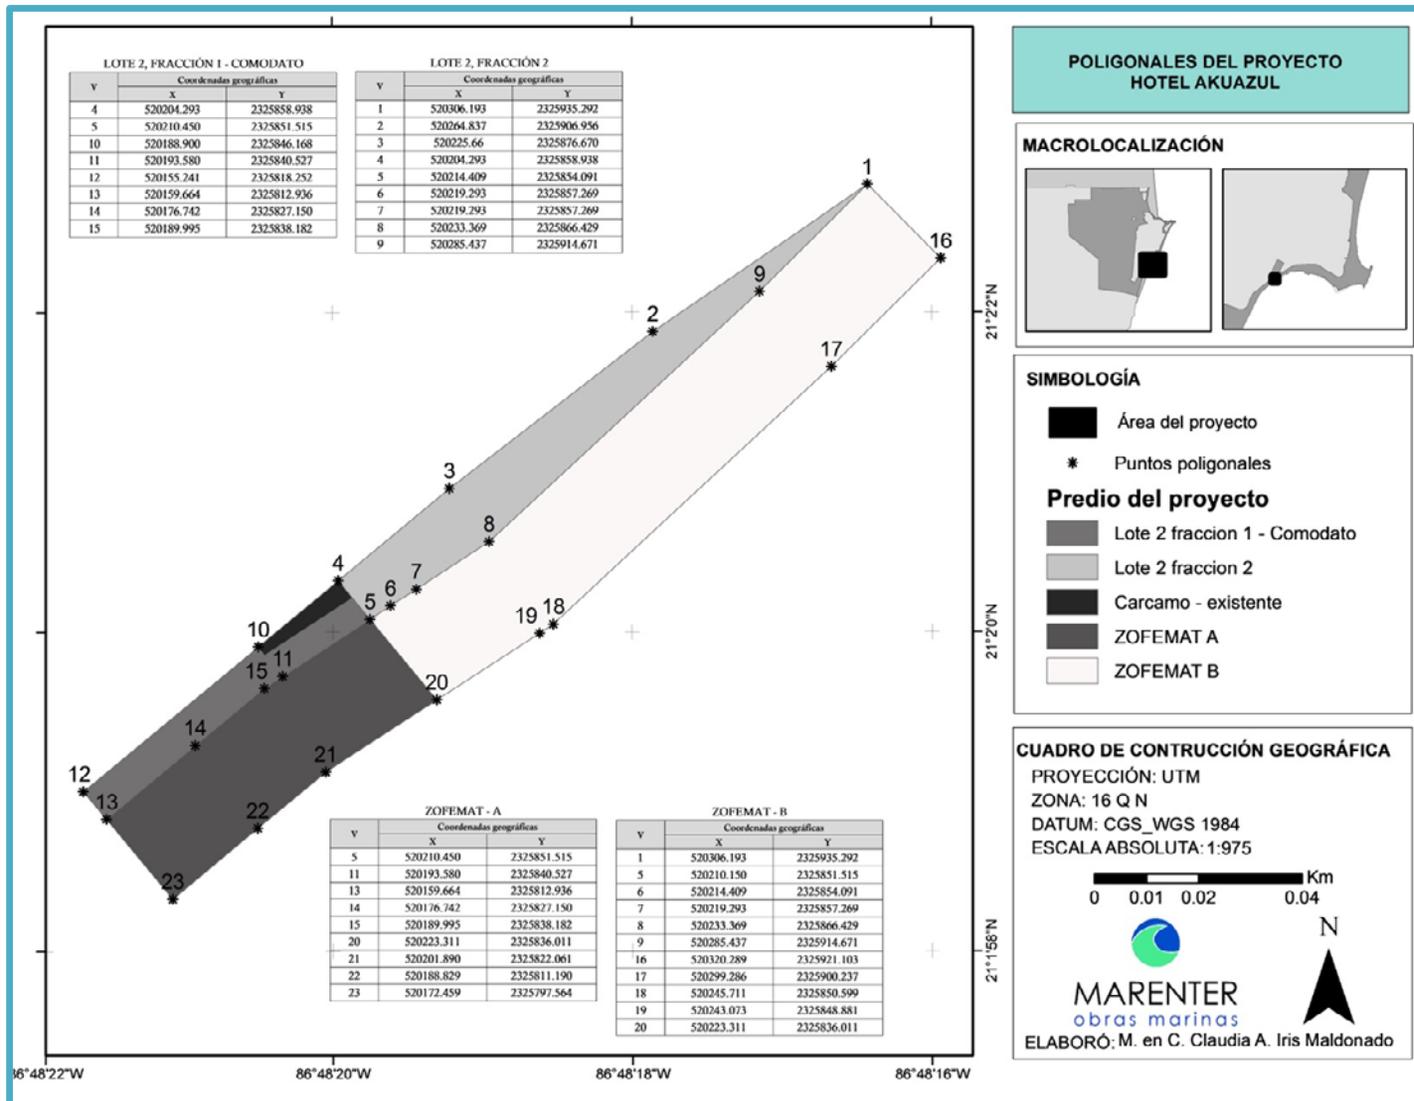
Plano de poligonales y coordenadas del proyecto.
